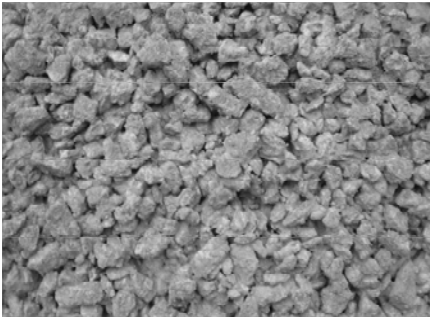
Фрагмент фільтрат бетону будівельний майданчик під м. Бориспіль.
